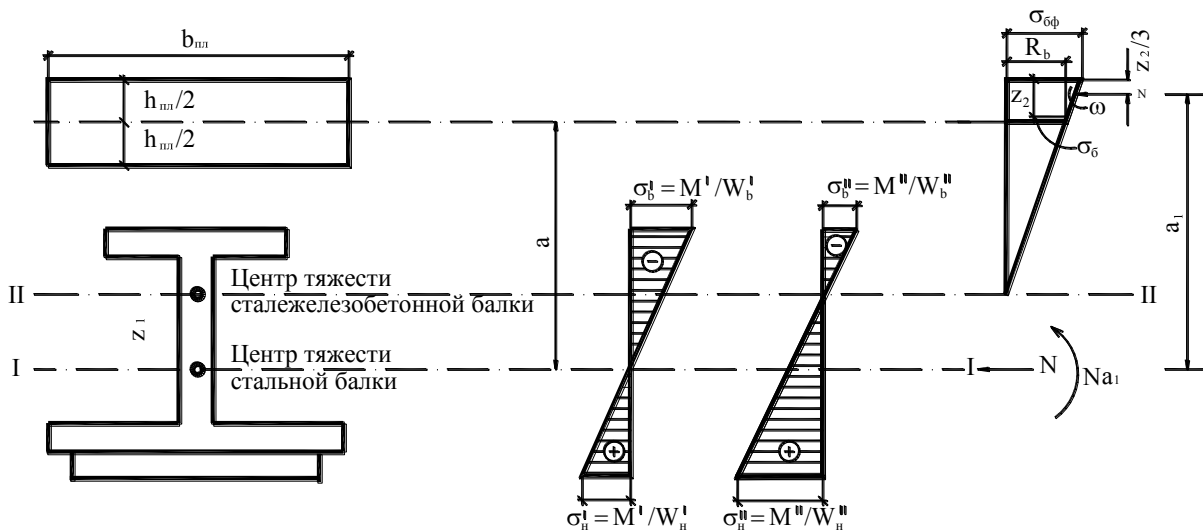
Эпюры нормальных напряжений от M^I и M^{II} в главной стальной балке и железобетонной плите
